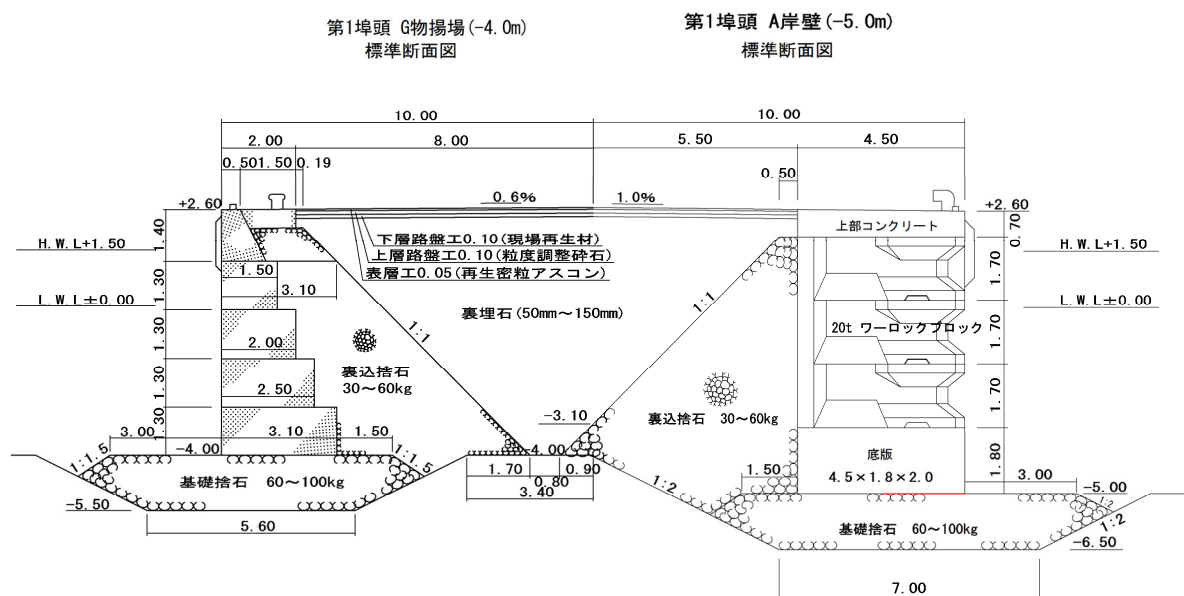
No.27 大洗港区\_第1埠頭 G 物揚場 (-4.0m) (水産ふ頭地区) の断面図 (被災前)
